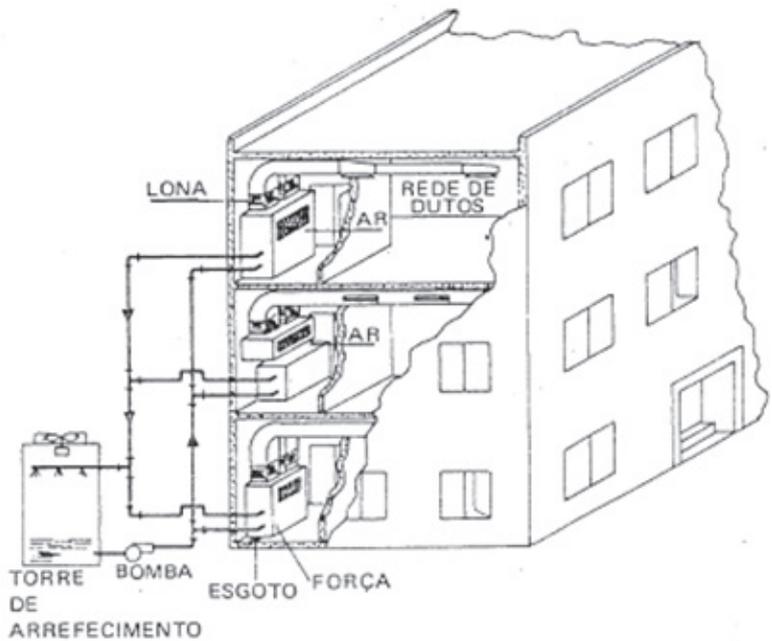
Torre de resfriamento situada no pavimento inferior
